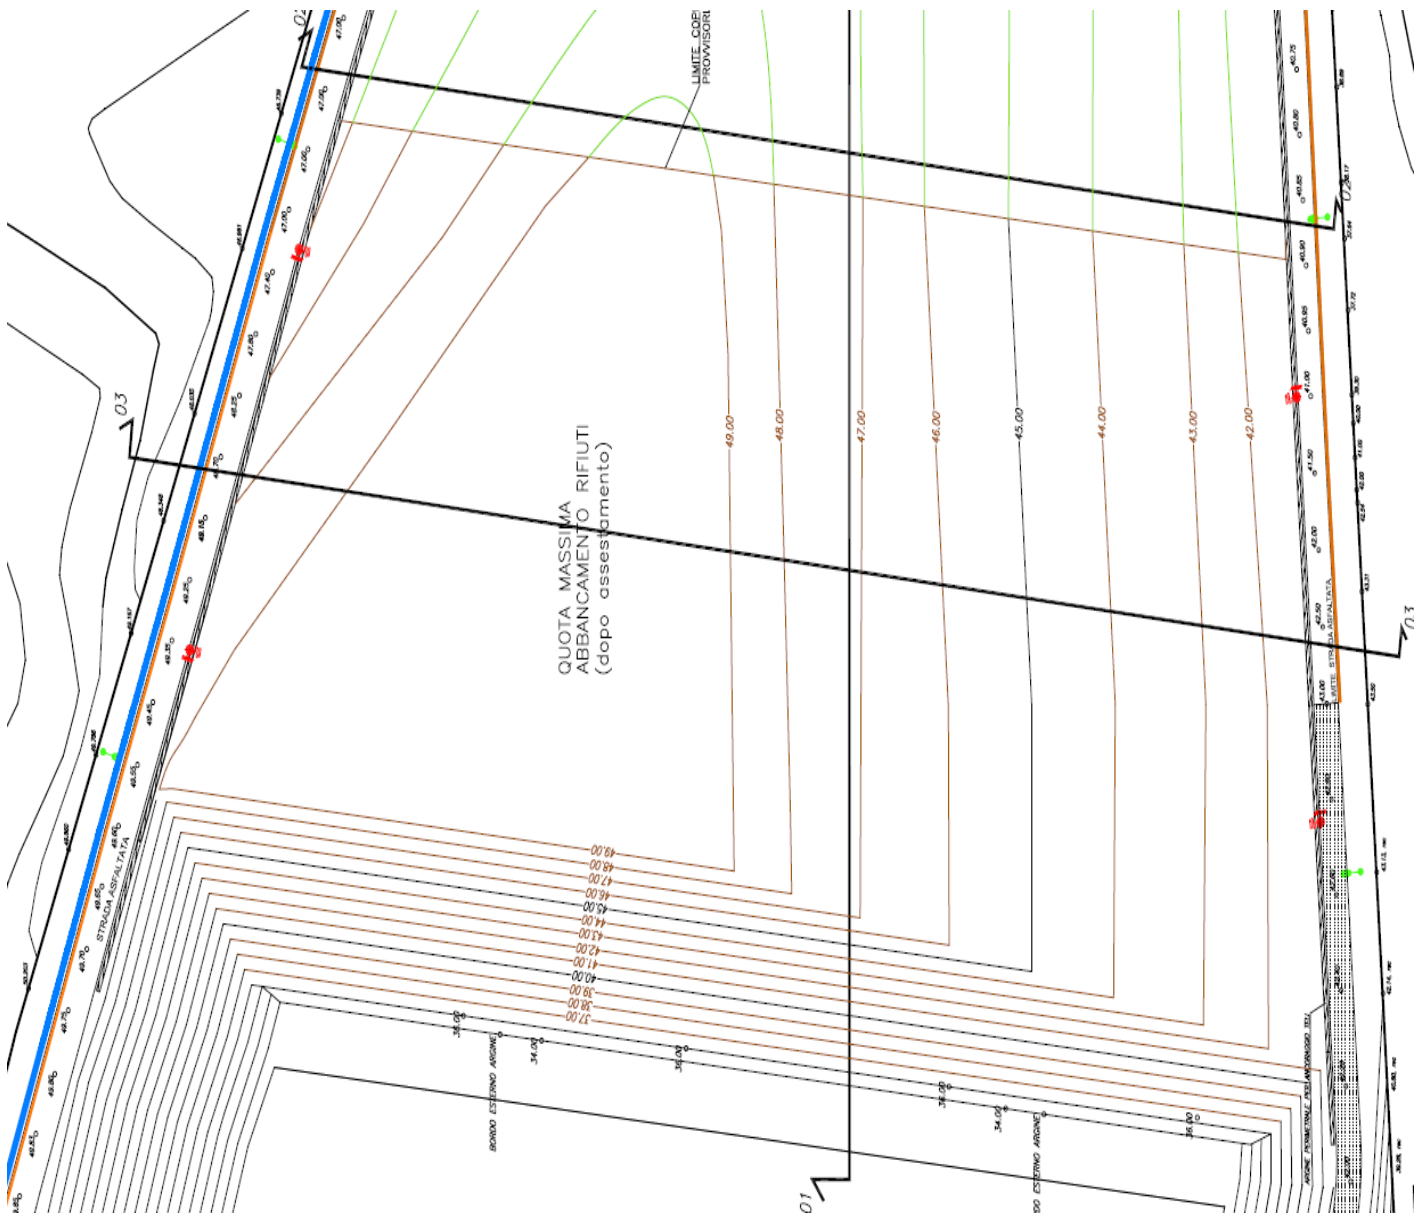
Estratto planimetria II lotto esaurito (ESTRO 2010)
